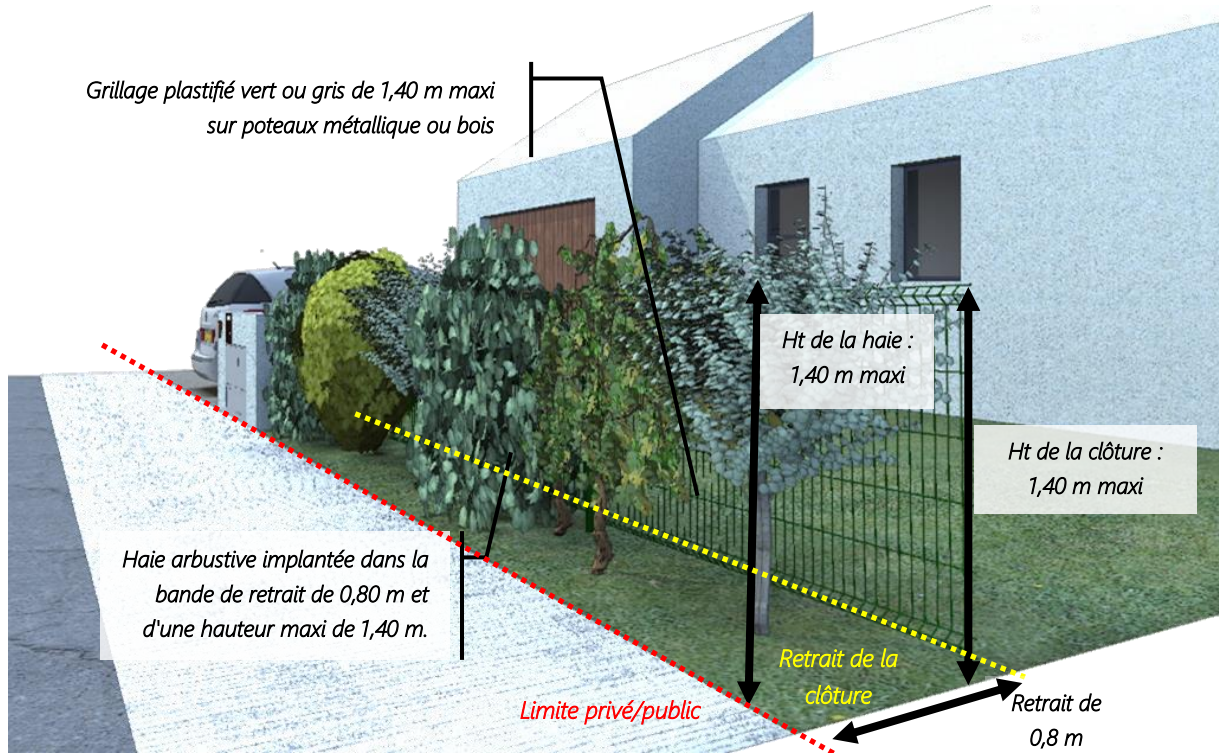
Principe d'implantation d'une clôture en retrait de 0.8 m
